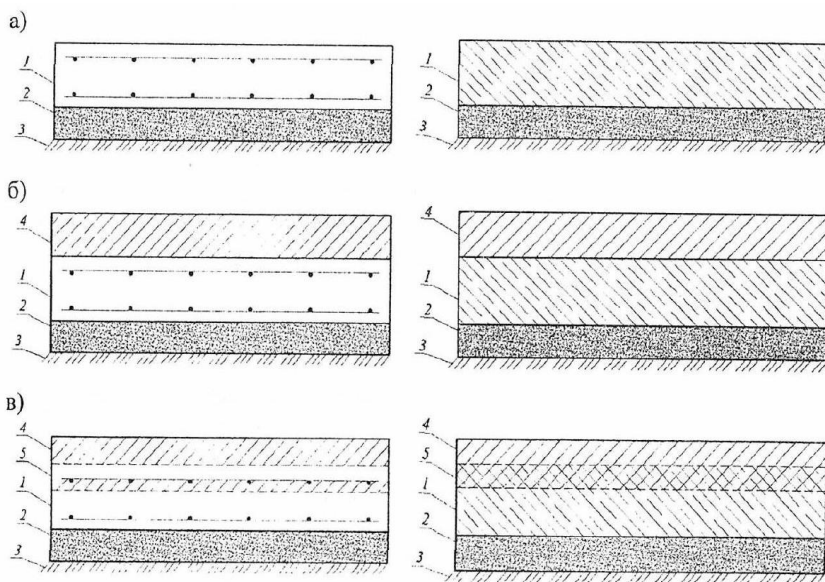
Конструктивно-технологические схемы устройства полов промышленных зданий: *а* – традиционный однослойный пол с железобетонной или бетонной плитой; *б* – двухслойный пол с износостойким слоем из фибробетона (работающий по двухслойной схеме); *в* – двухслойный пол с износостойким слоем из фибробетона, сращенным с железобетонной или бетонной плитой (работающий по однослойной схеме); 1 – несущая конструкция пола (железобетонная или бетонная плита); 2 – подготовка из песчано-грунтовой смеси; 3 – естественно уплотненное грунтовое основание; 4 – слой износа из фибробетона; 5 – слой сращивания фибробетона с бетоном несущей железобетонной или бетонной смеси
